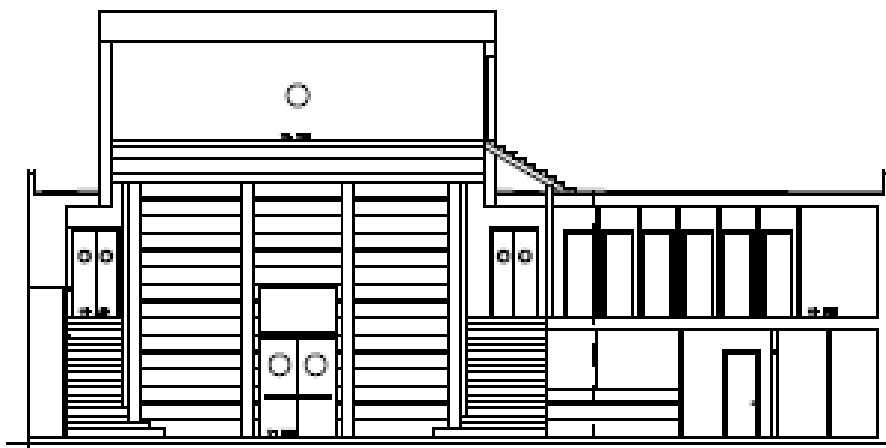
Plano Sección reformada* (MESA HURTADO, R., 1998).
